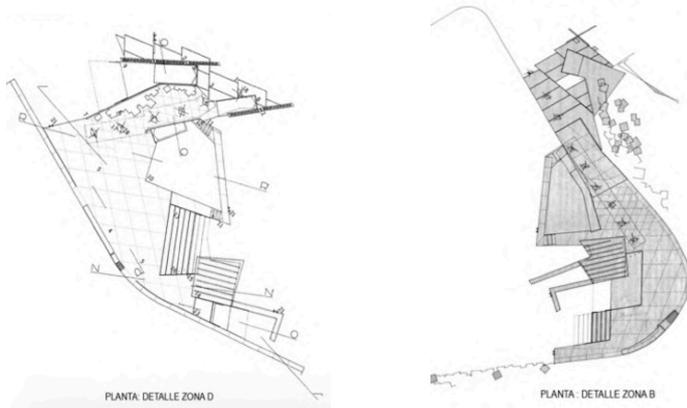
Detalles proyecto Paseo Juan Aparicio (1996). Fuente: COACV.
